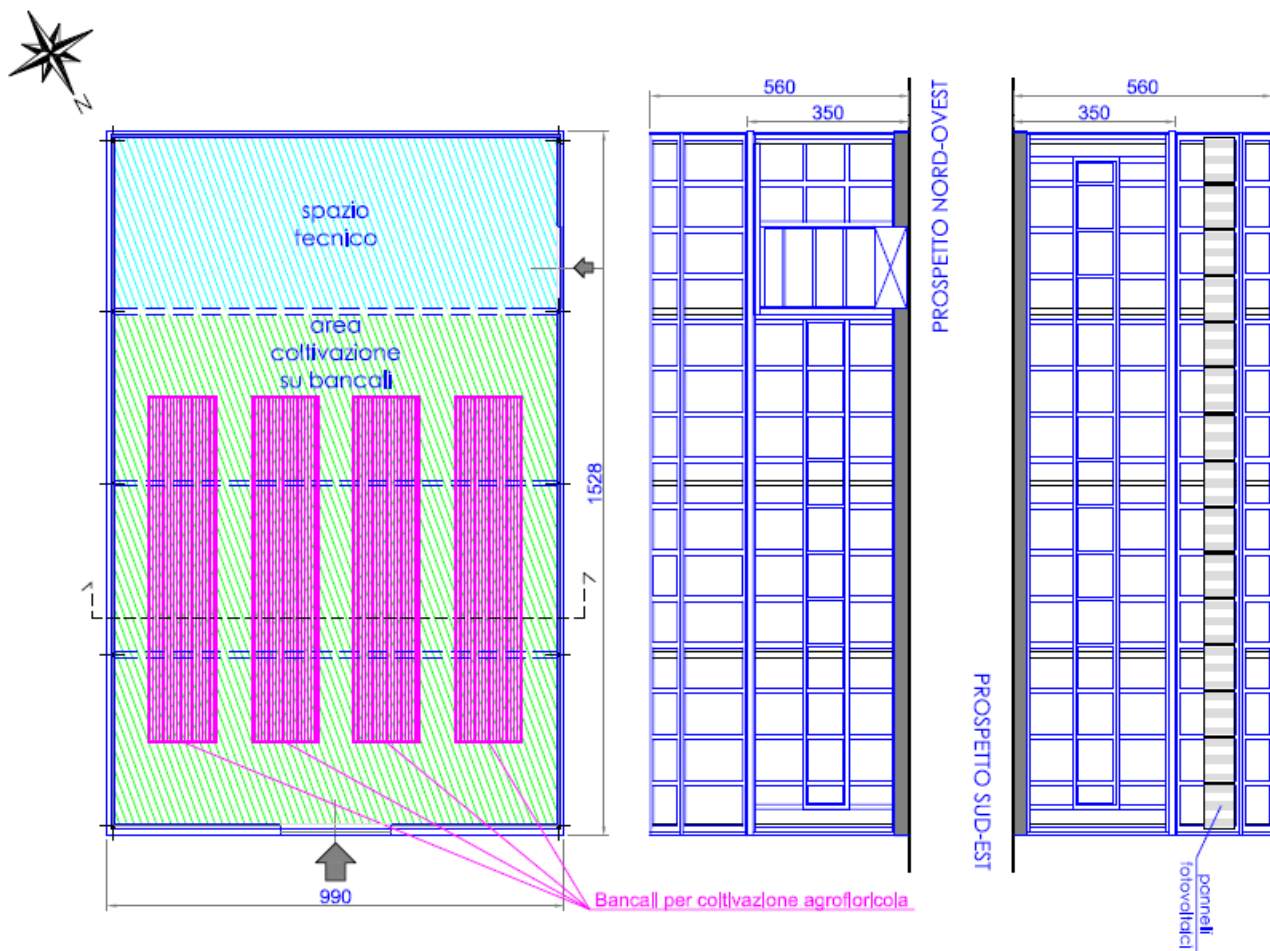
Tavola di progetto serra – Pianta e Prospetti laterali
